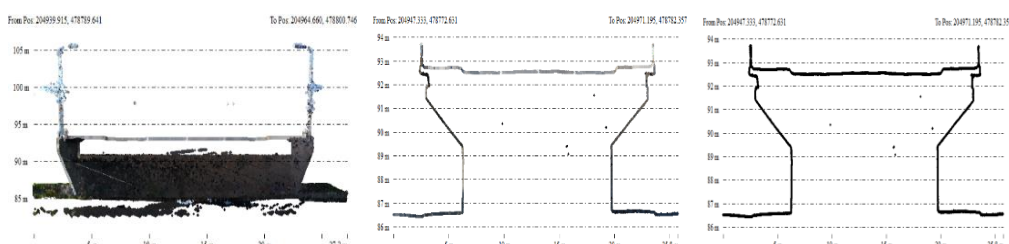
Secțiunile transversale ale pilelor și a suprastructurii
